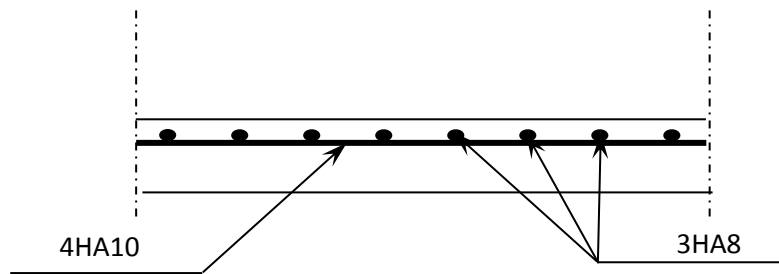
Schéma de ferraillage de la dalle pleine sur un seul appui
